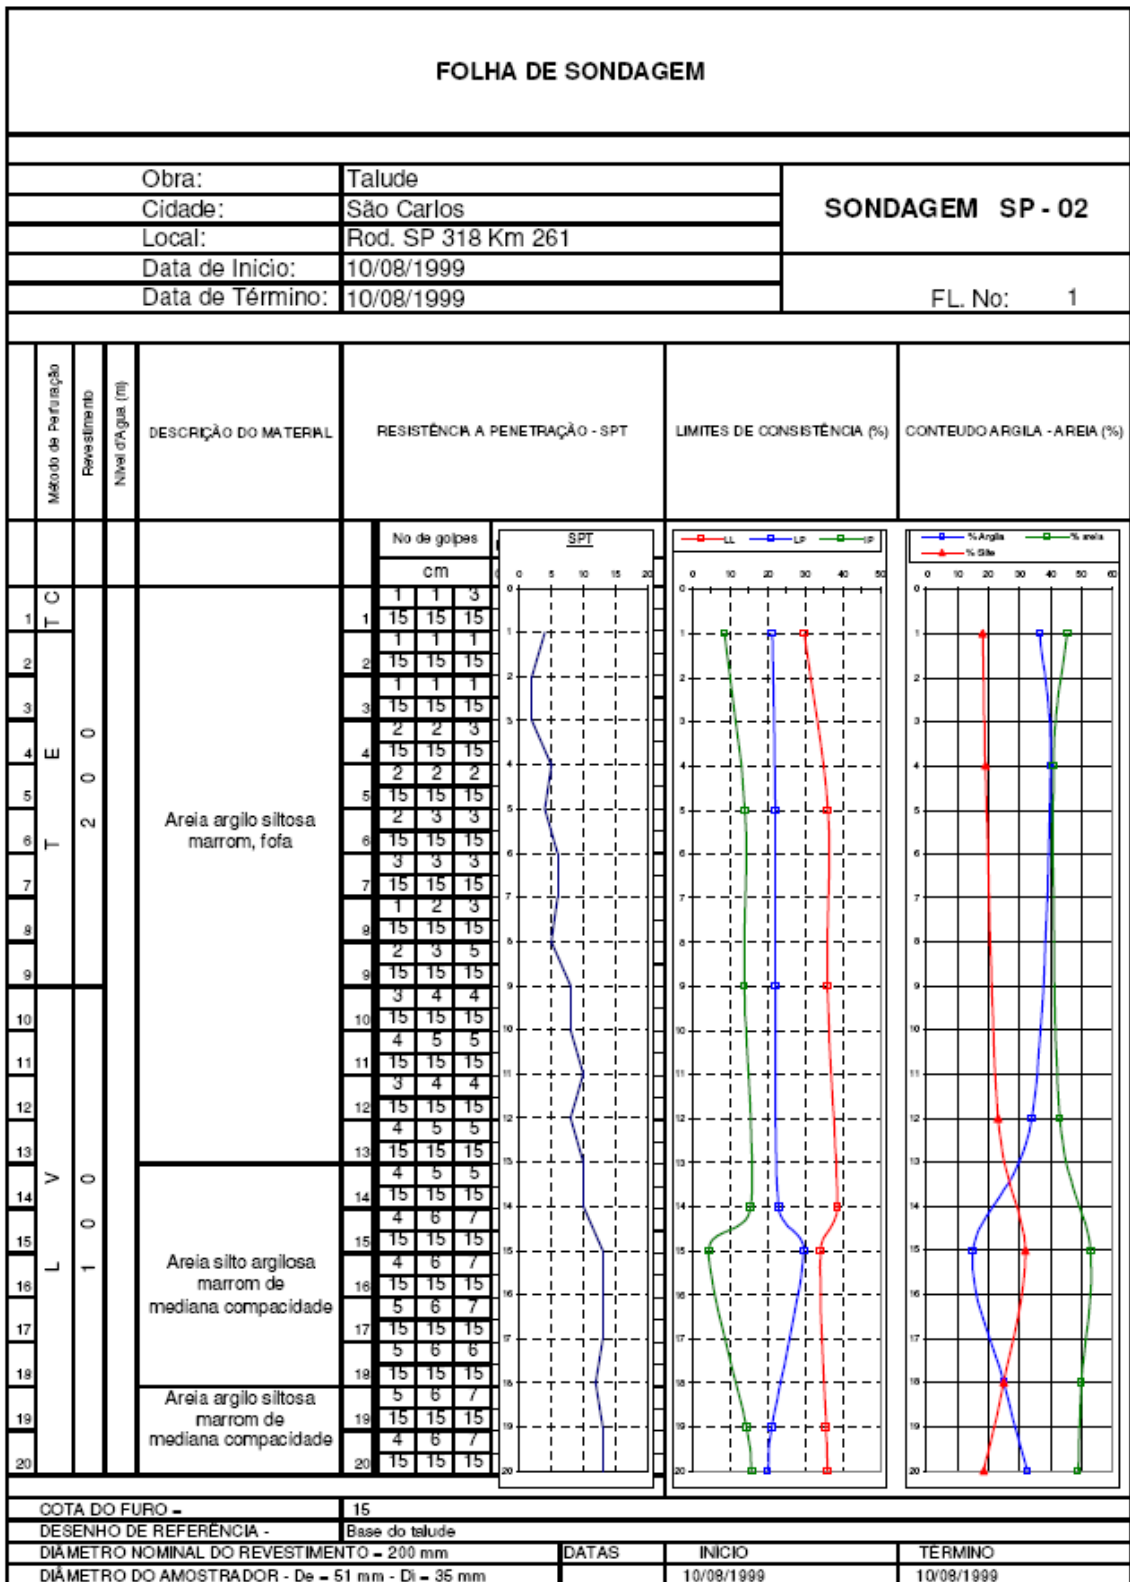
Perfil de Sondagem - SP-02 (Calle, 2000).
